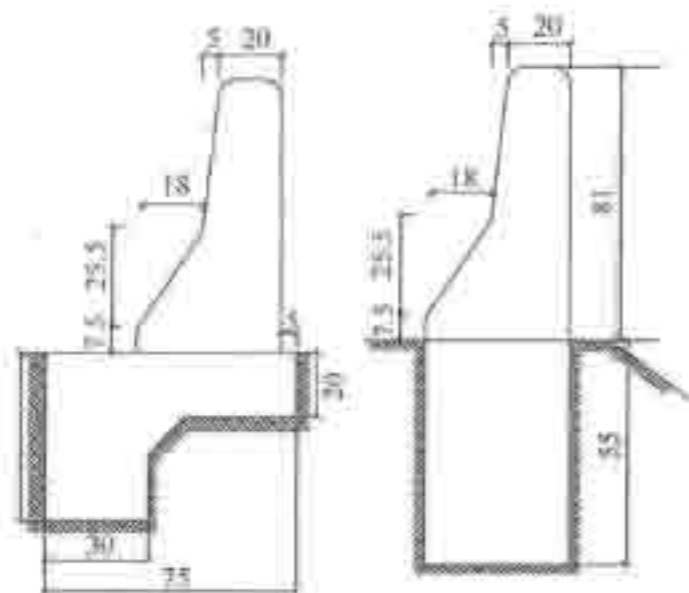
混凝土路侧护栏 (尺寸单位: cm)
